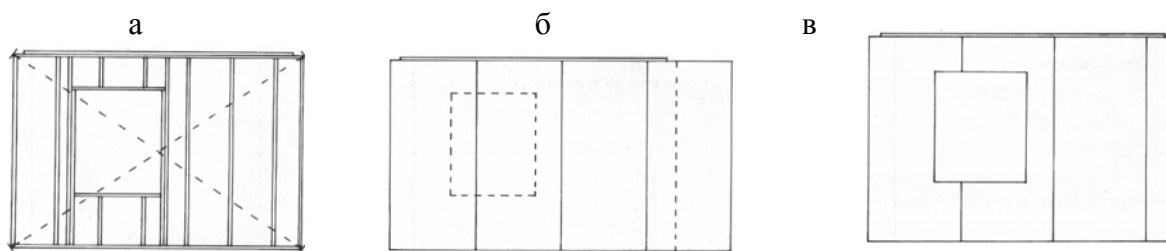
Обшивка наружной стороны стенового каркаса плитами:
